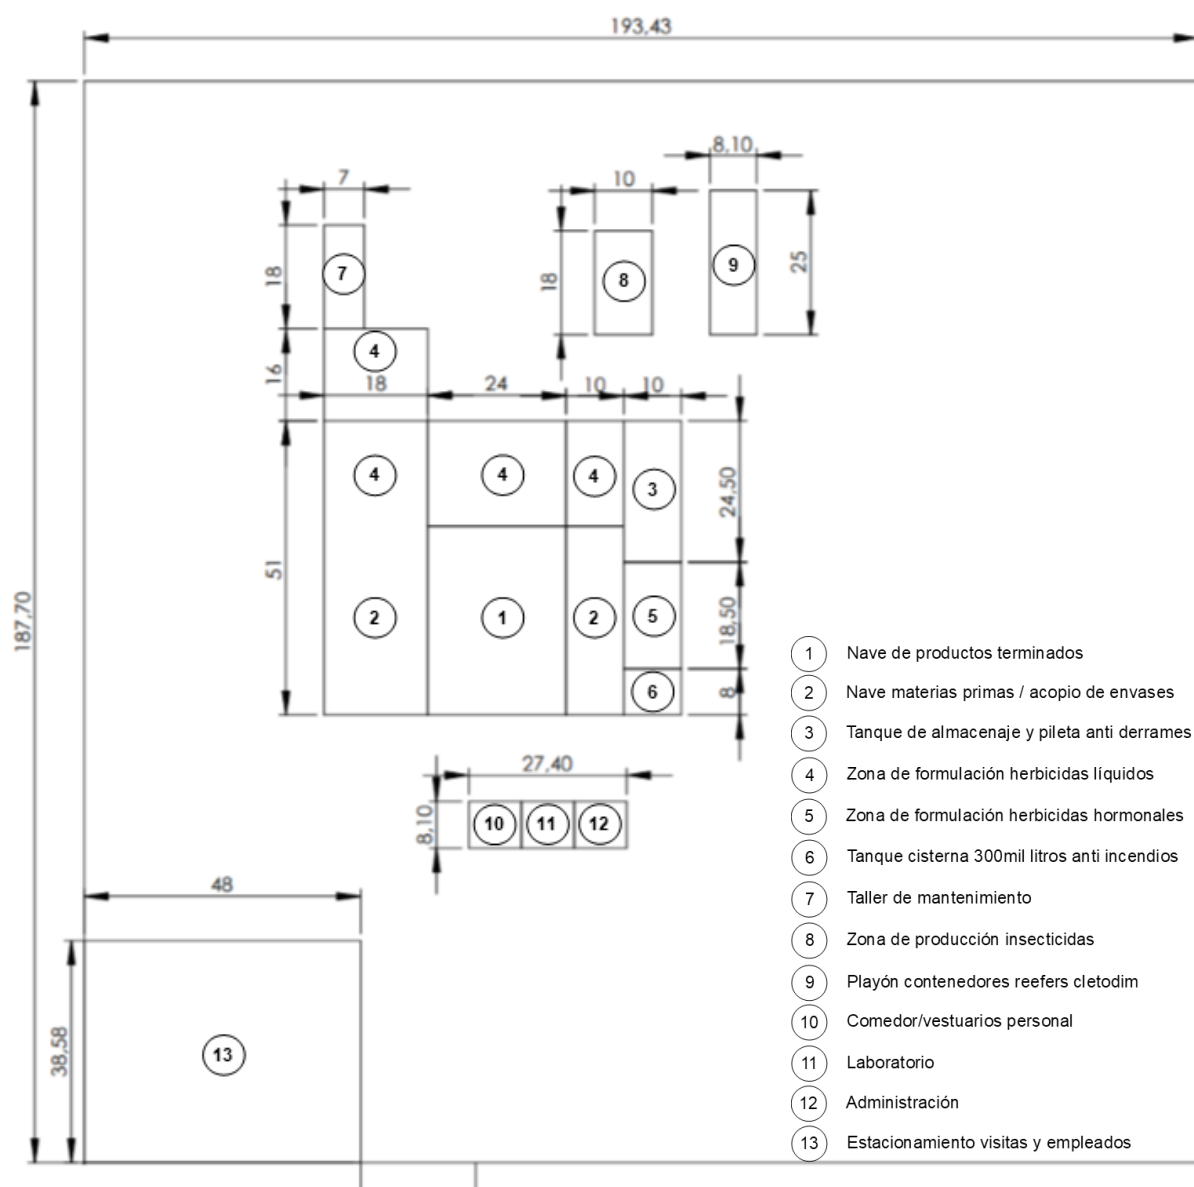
Layout actual de la planta de producción de Sigma Agro.
